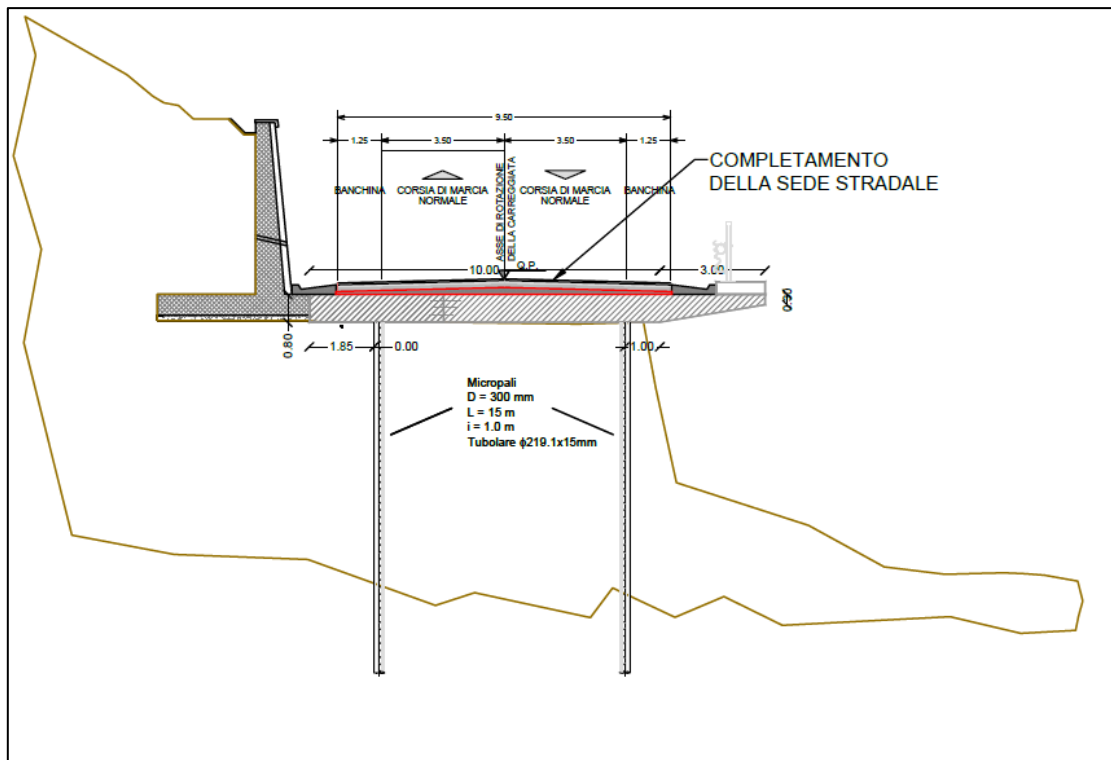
Sezione tipo 3 – Allargamento carreggiata lato valle con struttura a mensola
